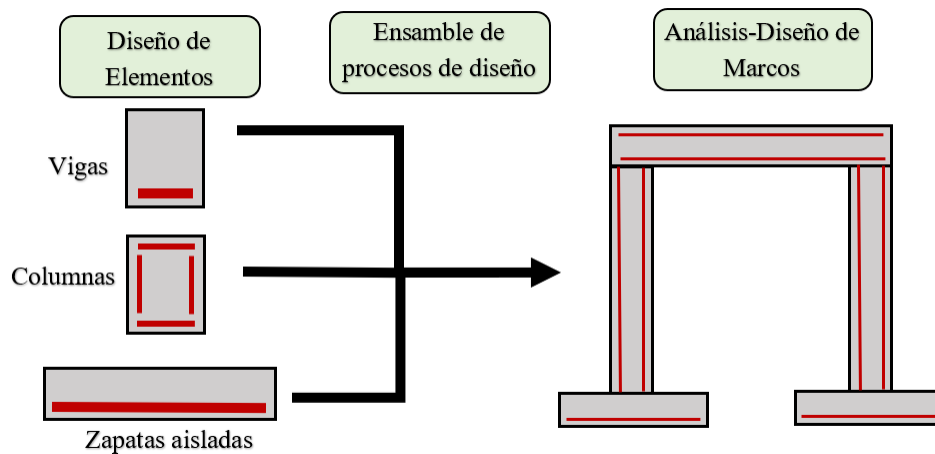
Ensamblaje de procesos de diseño de elementos estructurales de concreto reforzado para análisis-diseño de marcos de concreto reforzado.
